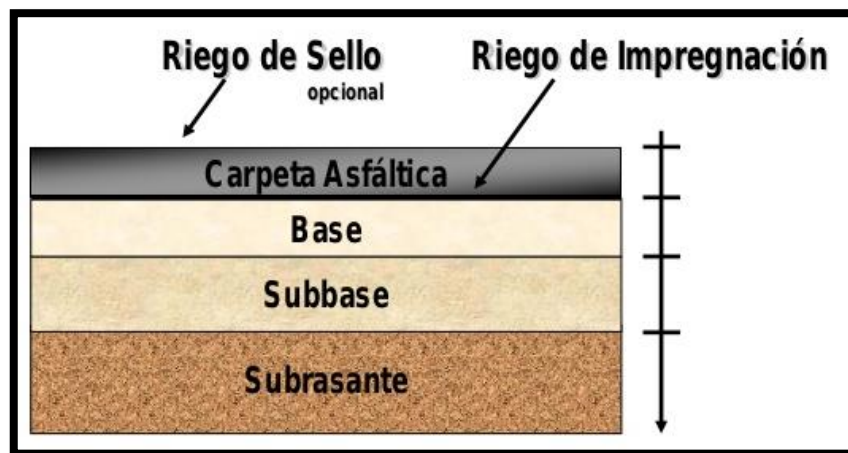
, Sección Transversal de un Pavimento Flexible.
